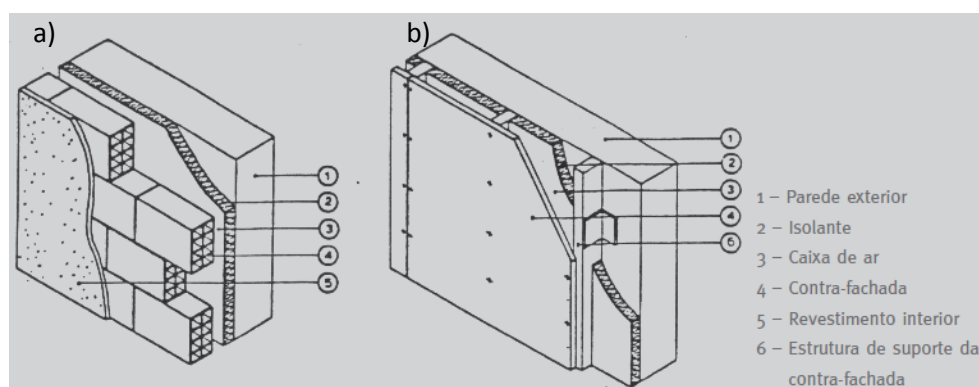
Contra fachada com isolante na caixa-de-ar: a) Contra fachada de alvenaria; b) Contra fachada de gesso cartonado [34]
